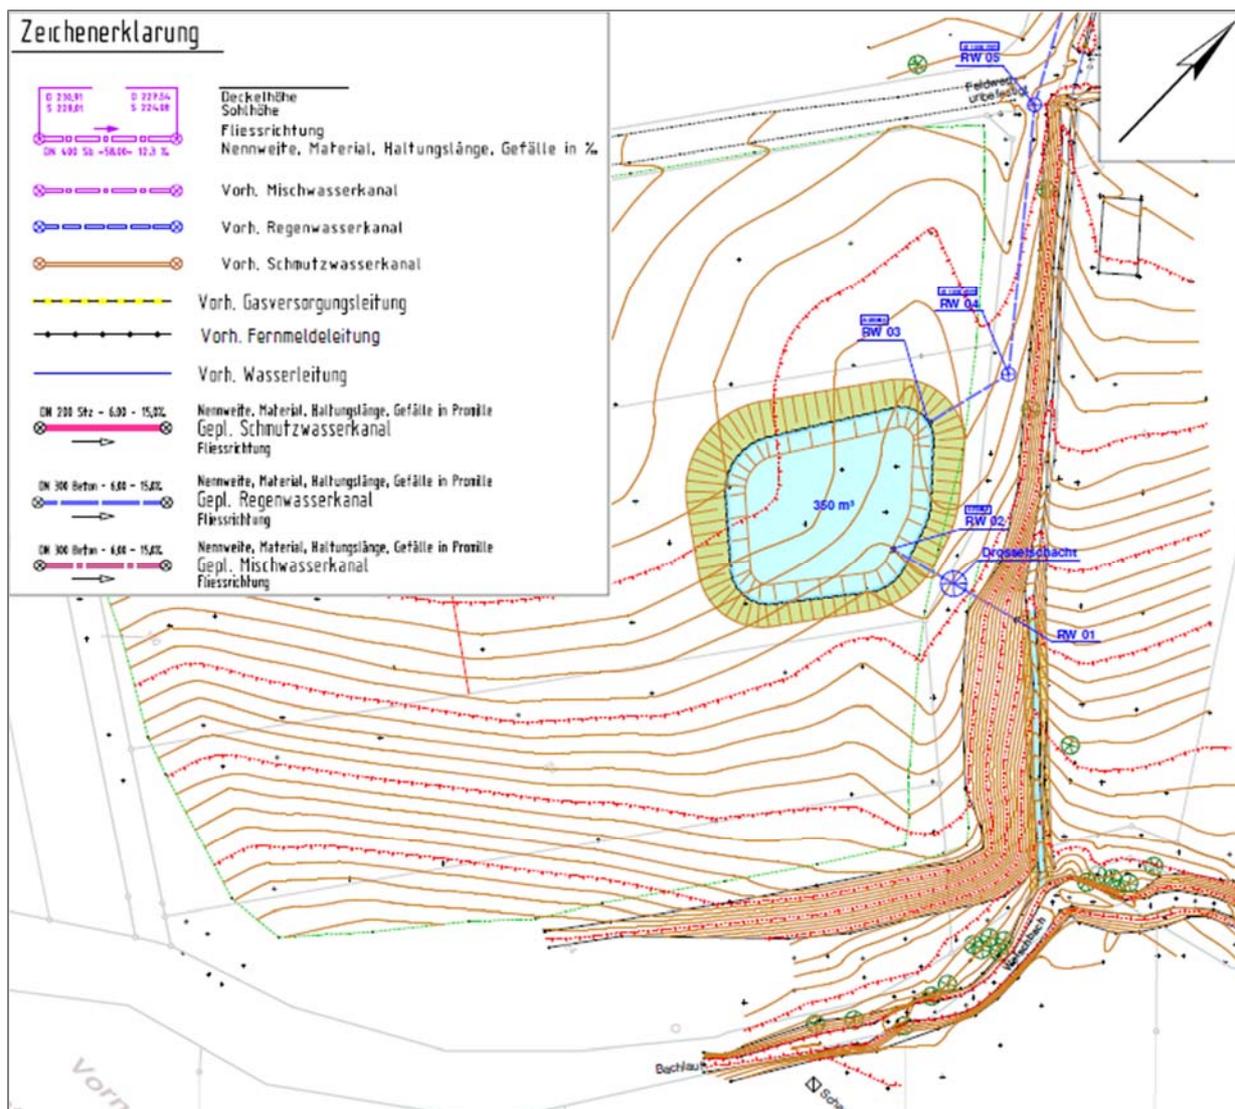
Lage des geplanten RRBs. Ausschnitt Lageplan Kanalplanung (Ingenieurbüro Zick-Hessler 2018).
